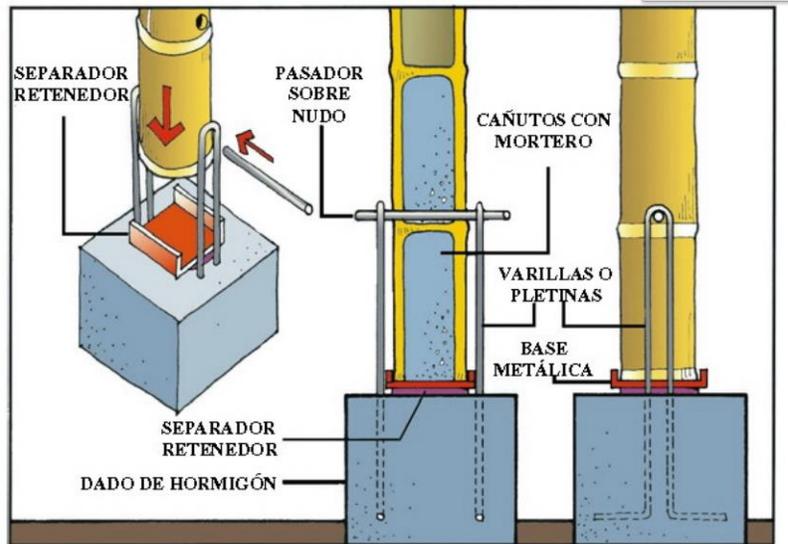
Unión pie-derecho a cimiento, en muros de bahareque sin soleras de madera.
